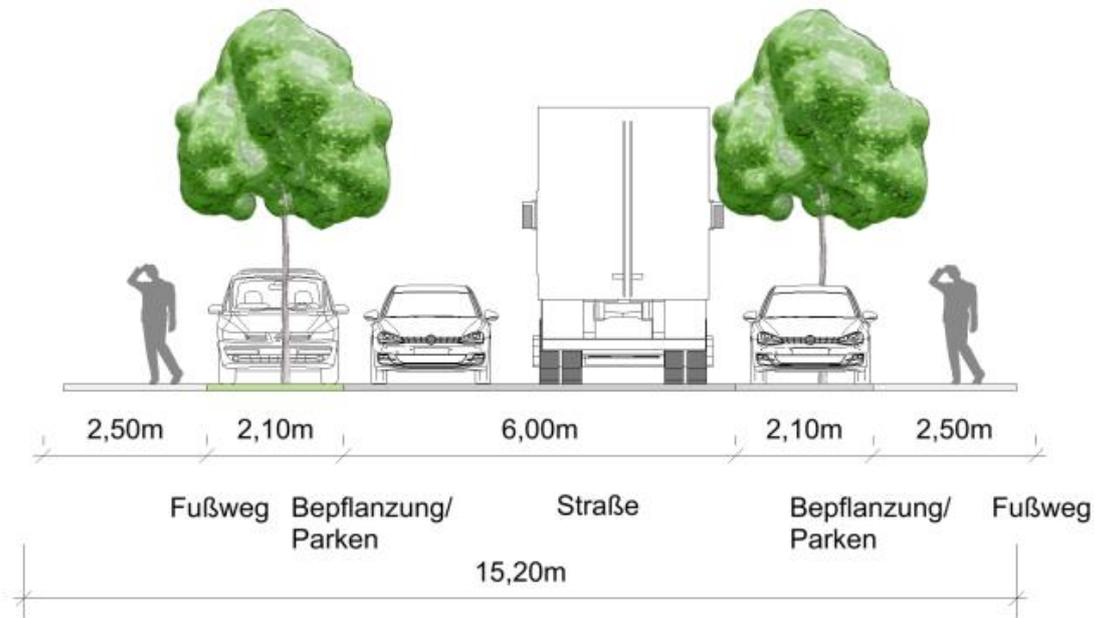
Möglicher Straßenquerschnitt Planstraße A
